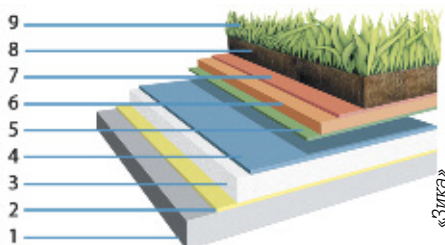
Конструкция озелененной кровли: 1 – несущее основание; 2 – пароизоляция; 3 – теплоизоляция (пенополистирол); 4 – гидроизоляционная кровельная мембрана (ТПО); 5 – защитный слой (геотекстиль); 6–9 – балласт (6 – дренаж; 7 – фильтрующий слой; 8 – растительный грунт; 9 – зеленые насаждения)
